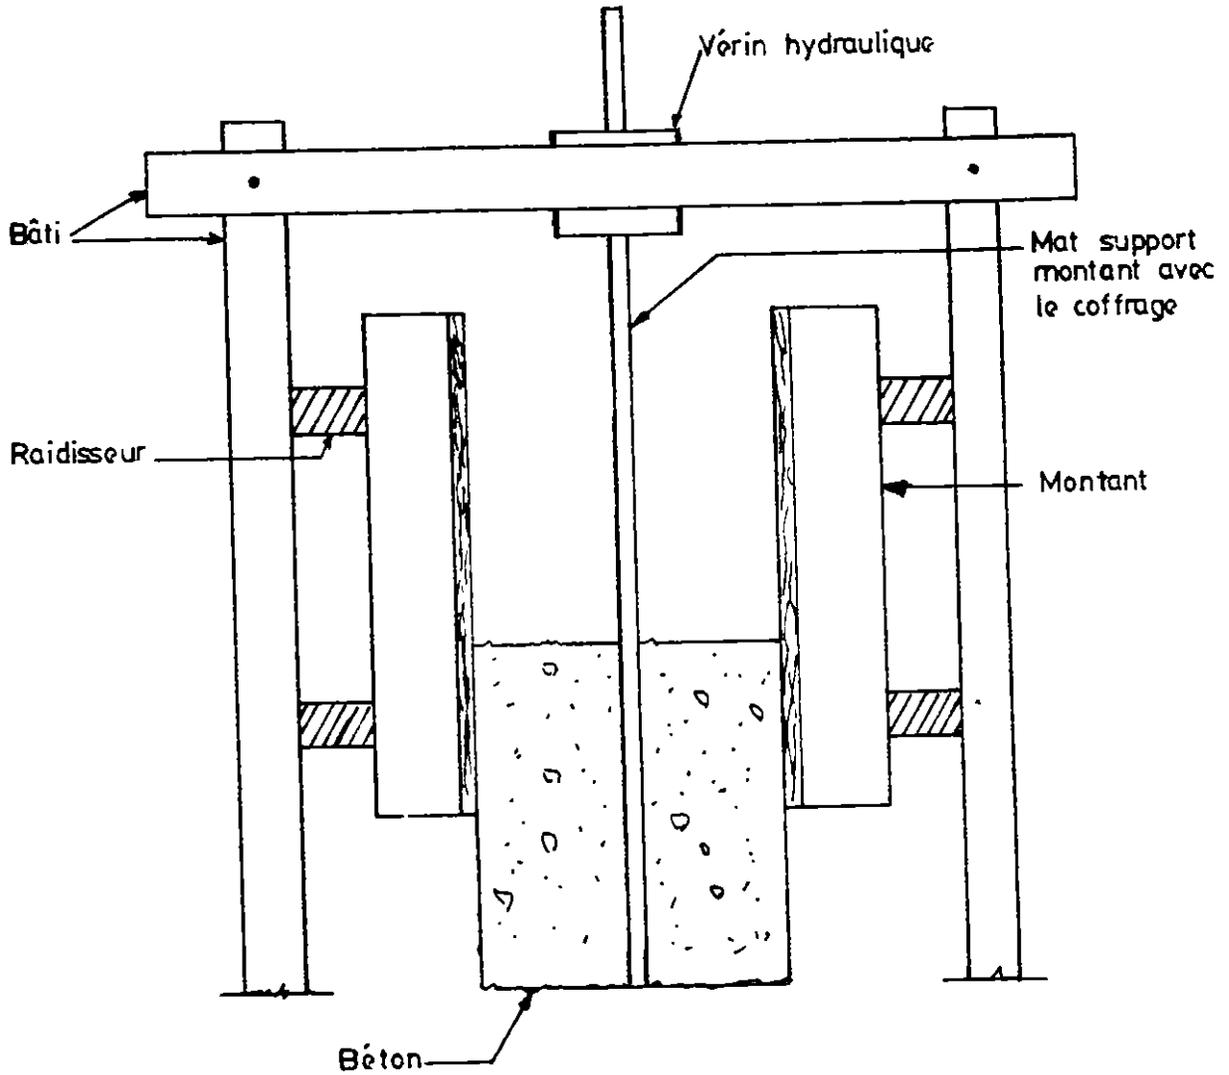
Coupe schématique de coffrage glissant pour murs (face à face)
